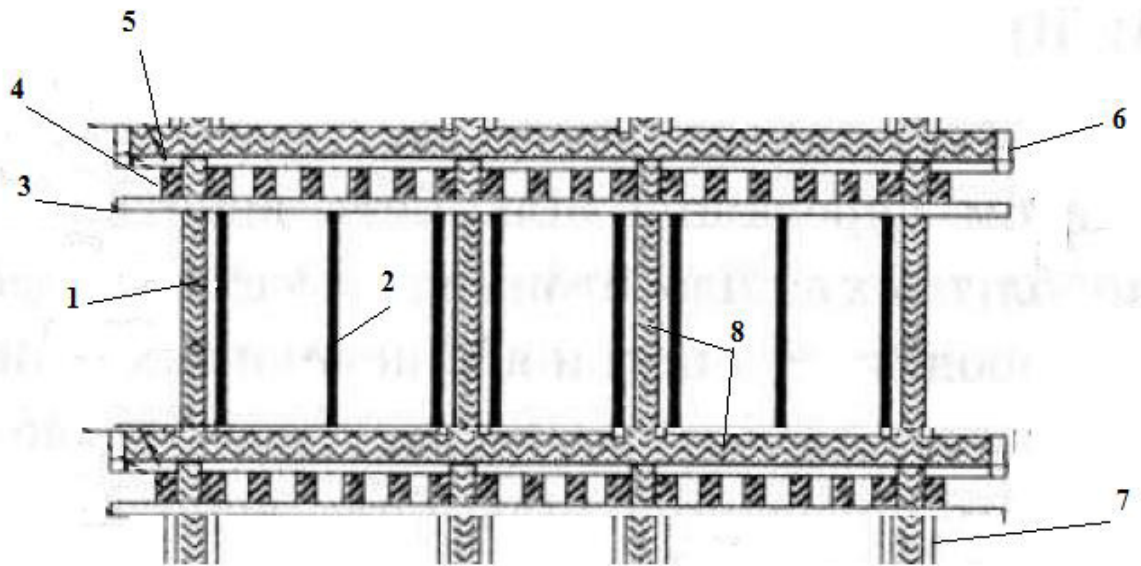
Схема елементів монолітного залізобетонного каркасу:
